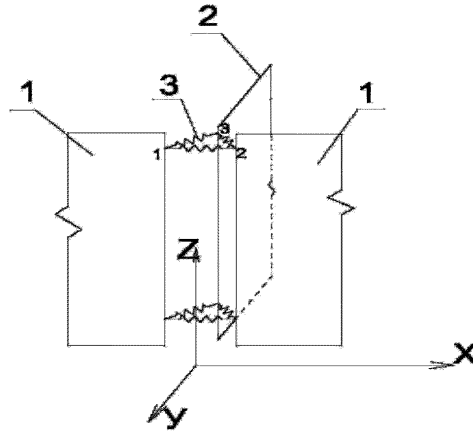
Схема расположения связей между стеновыми панелями в вертикальном стыке при соединении панелей на сварке через закладные детали: 1 – стеновая панель продольного направления; 2 – стеновая панель поперечного направления; 3 – упругие связи
